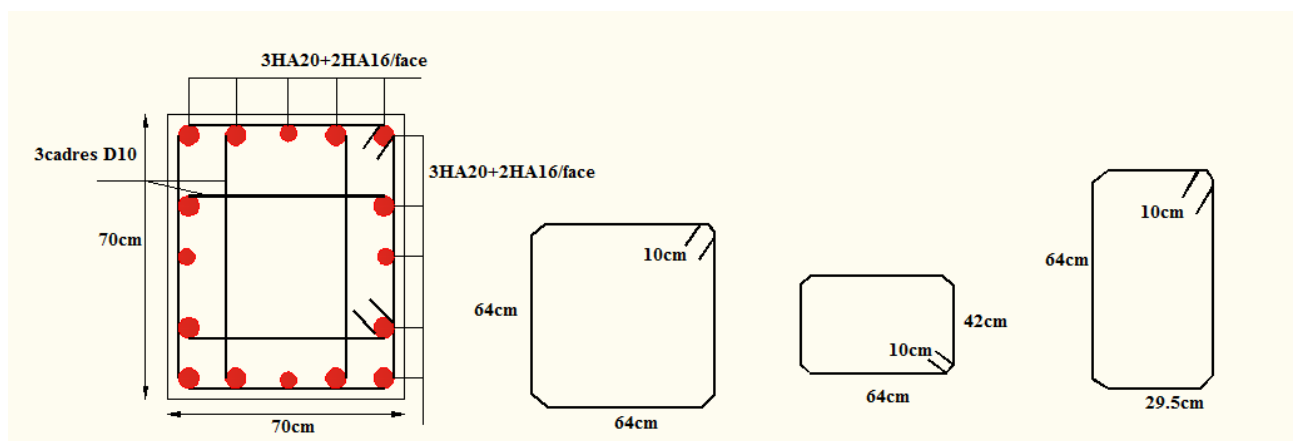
Schéma de ferrailage des poteaux d'étage 2
